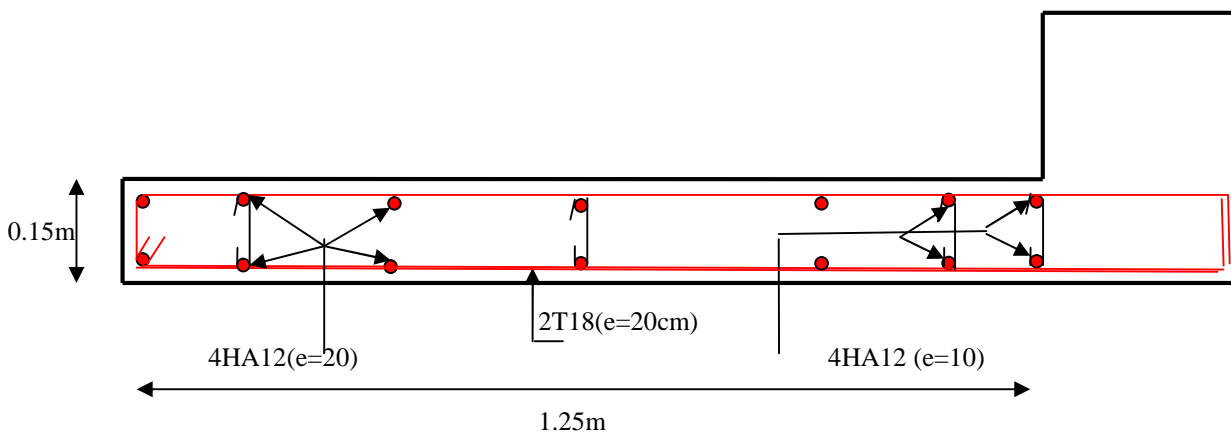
Schéma de ferrailage du voile terrasse sens y-y
